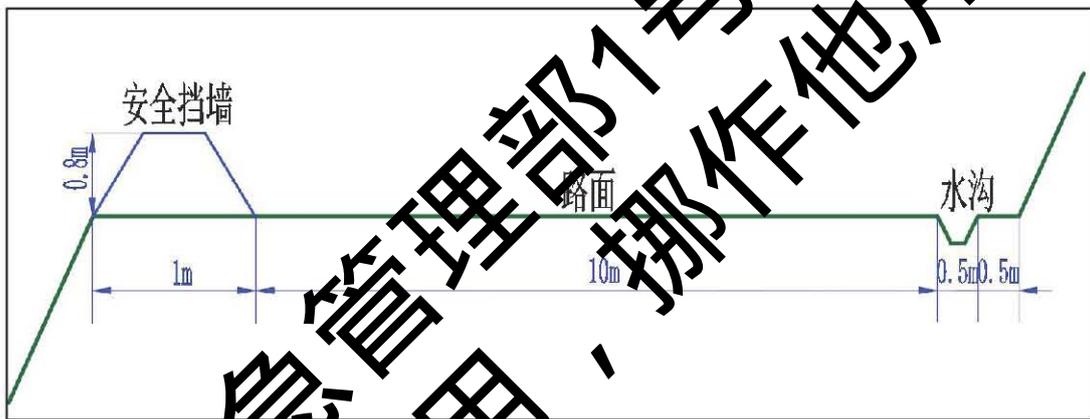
道路组成要素见汽车运输道路横断面示意图
